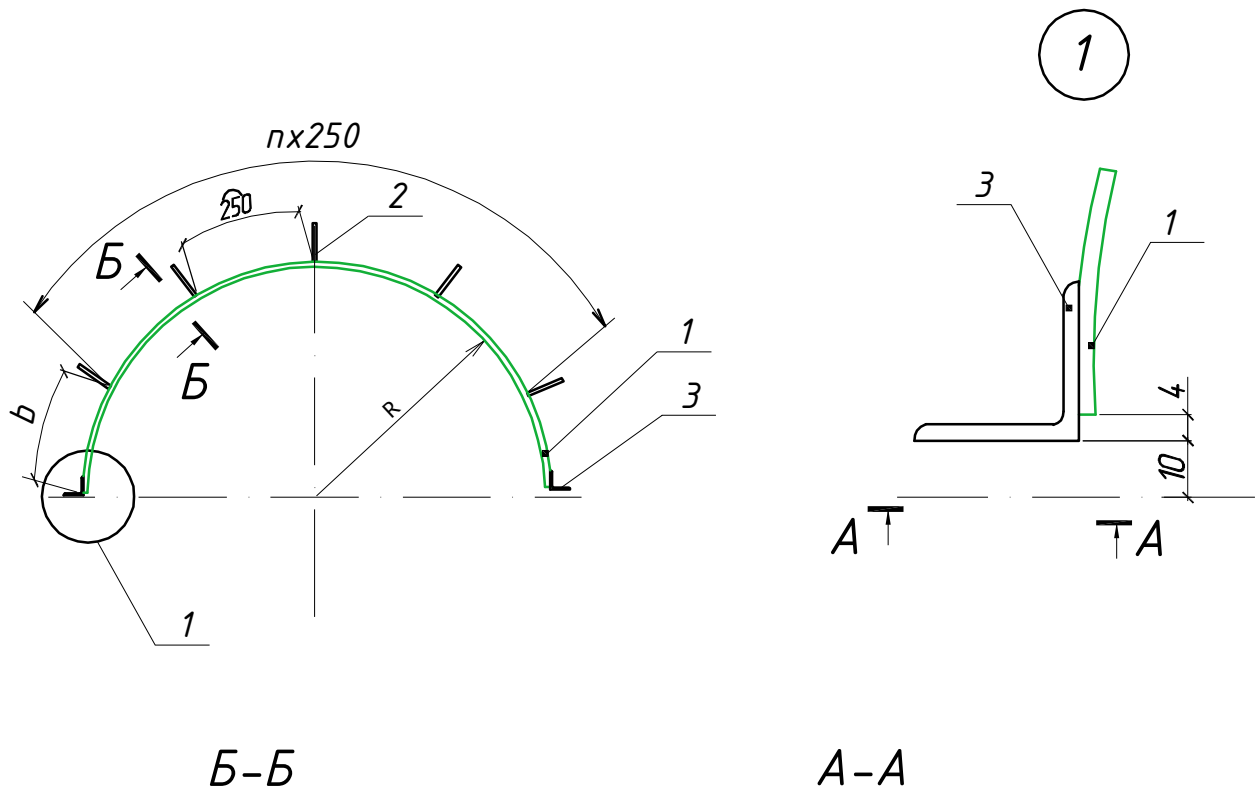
Бандаж стяжной (для вертикальных трубопроводов d_n от 45 до 159 мм)
